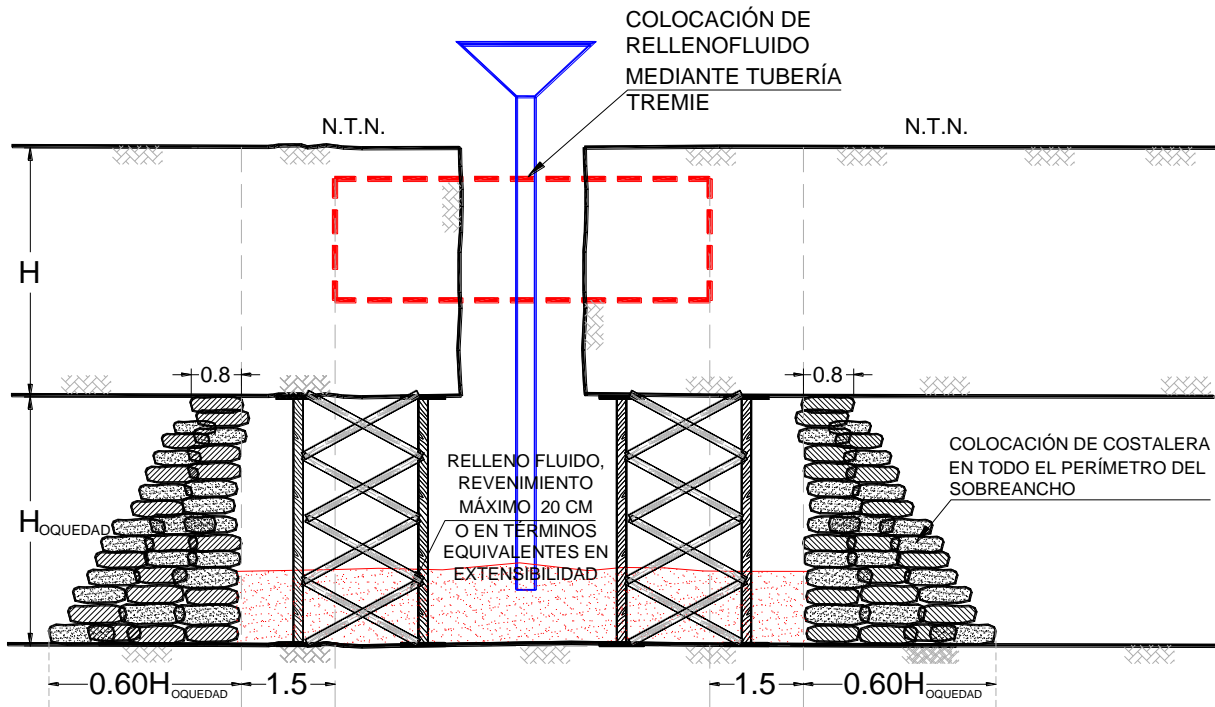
Relleno de caverna, uso de tubería Treamie. Pilas en Zona Minada
